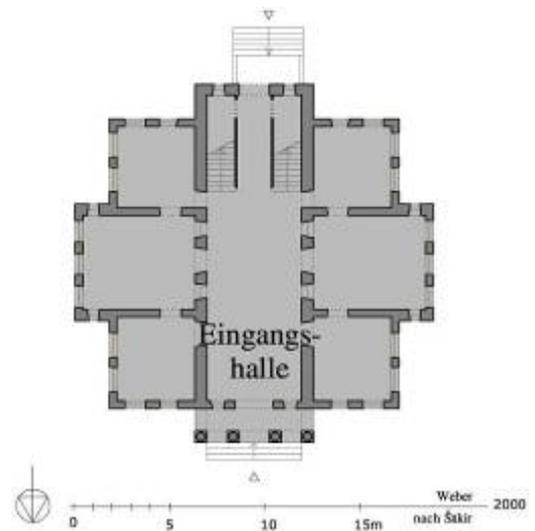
Grundbuchamt [338], Grundriss EG
